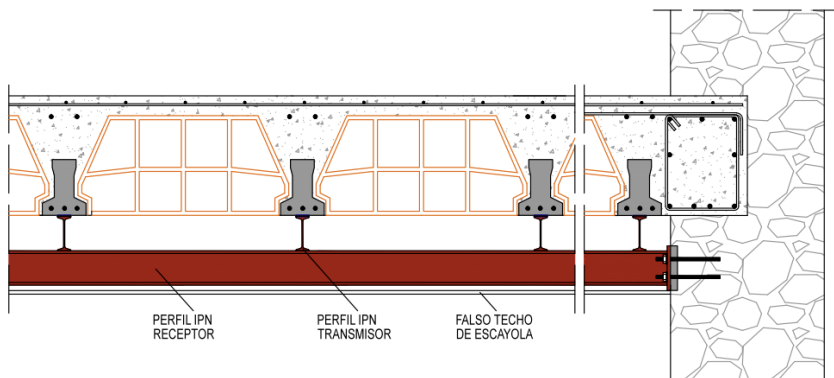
Propuesta de intervención para el refuerzo de forjado. Fuente propia.
